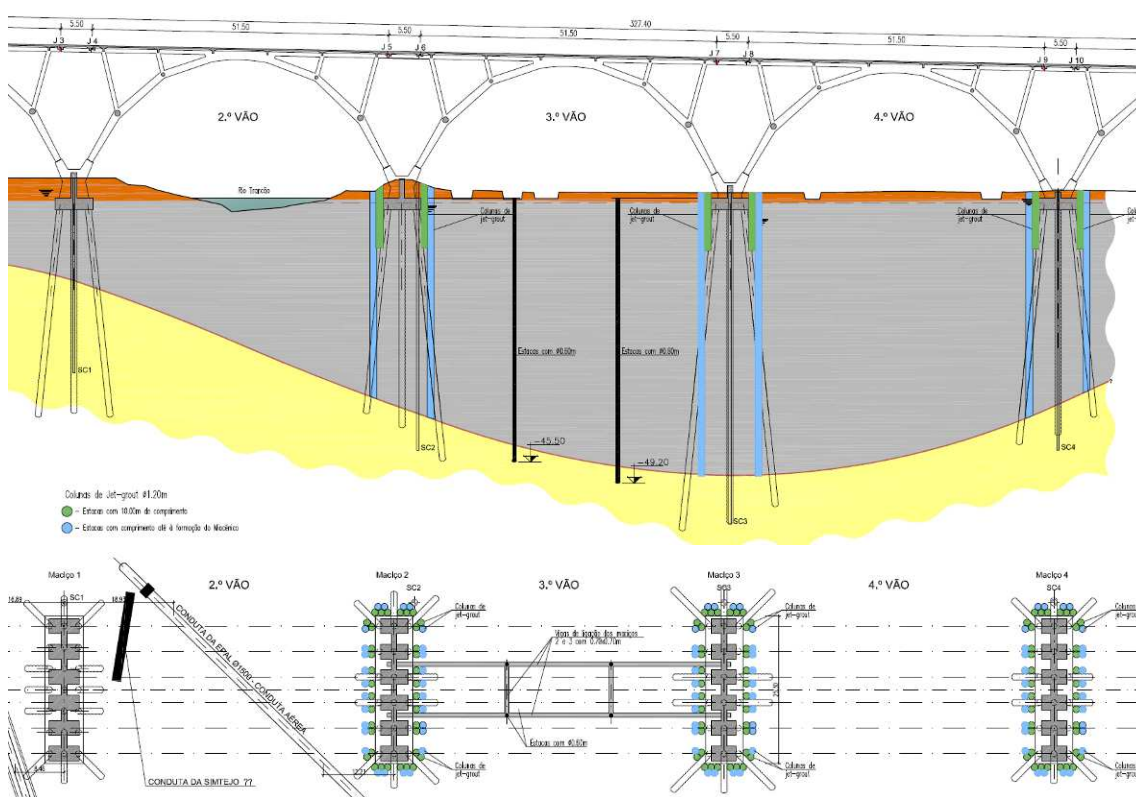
Reforço das fundações com colunas de *jet grouting*.
